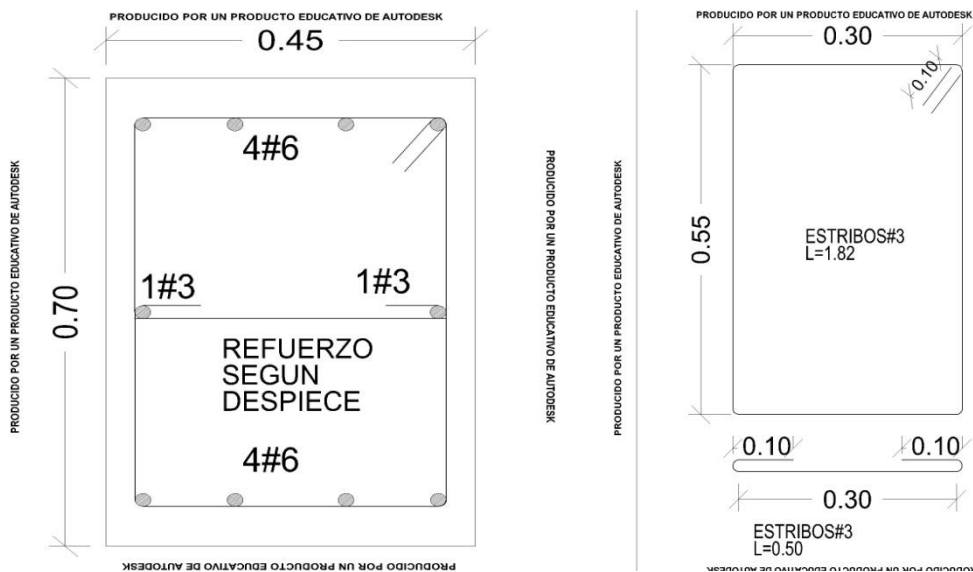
Dimensiones y refuerzo a cortante de las vigas de cimentación.
